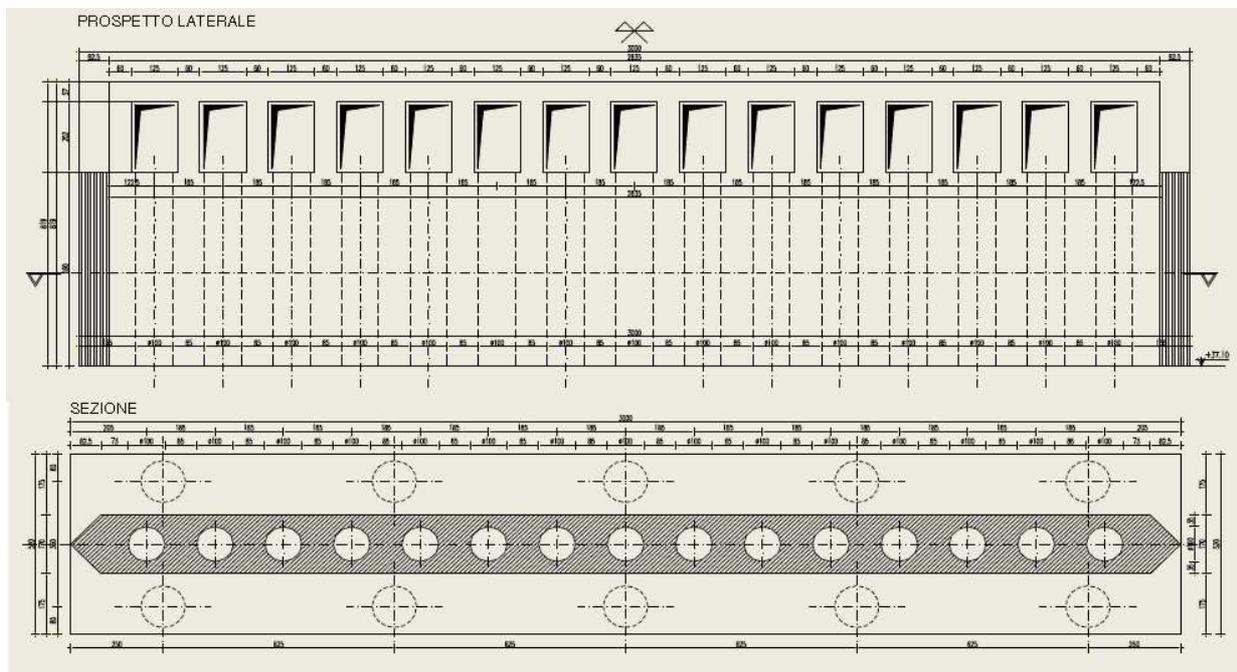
prospetto pila e sezione fondazioni (da progetto originale).
